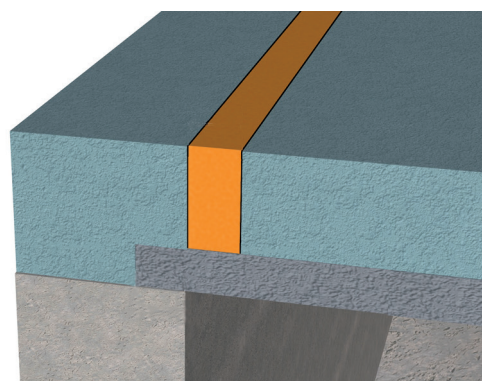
Rupteur intégré à la prédalle (prédalle posée)
